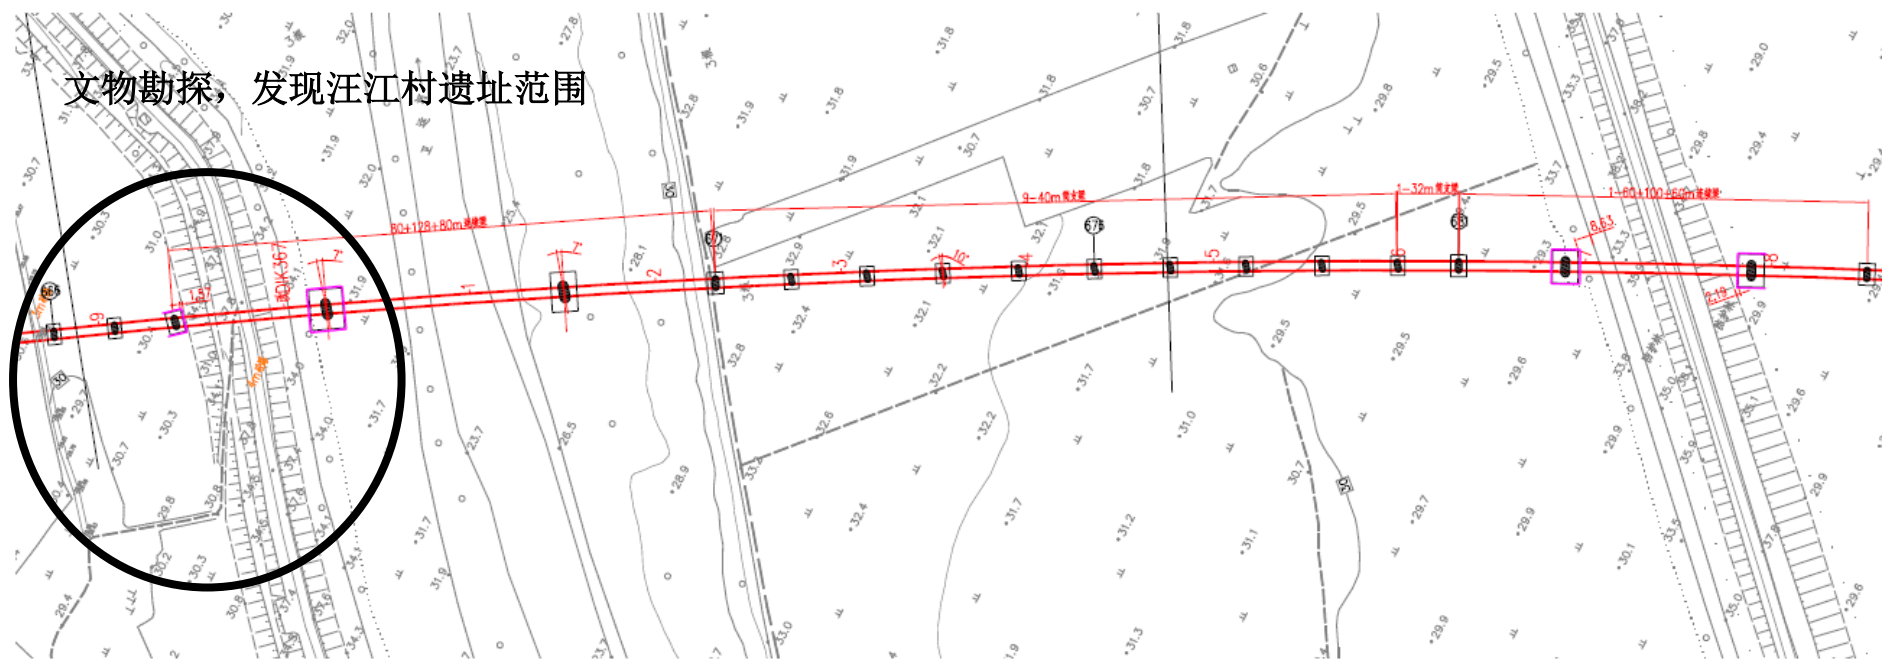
京雄商高铁卫河段桥梁平面布置图
